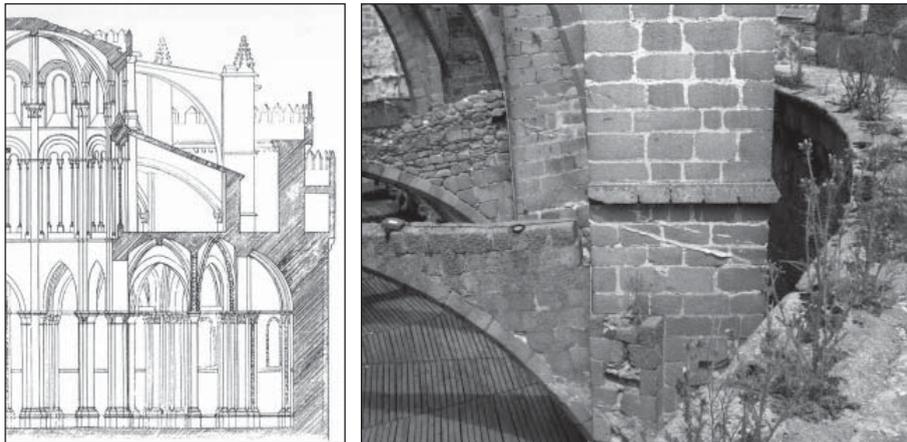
Fotografía donde se evidencia la señal en el contrafuerte de la cubierta a un agua. Sección que tendría la cubierta de madera sobre la tribuna, tras desmantelar la primera cubierta de piedra, en el siglo XIV (Gómez-Moreno, 1900).
